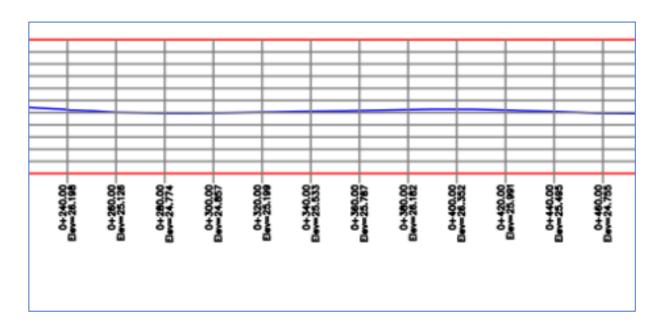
Vista 3 - Perfil longitudinal San Isidro
